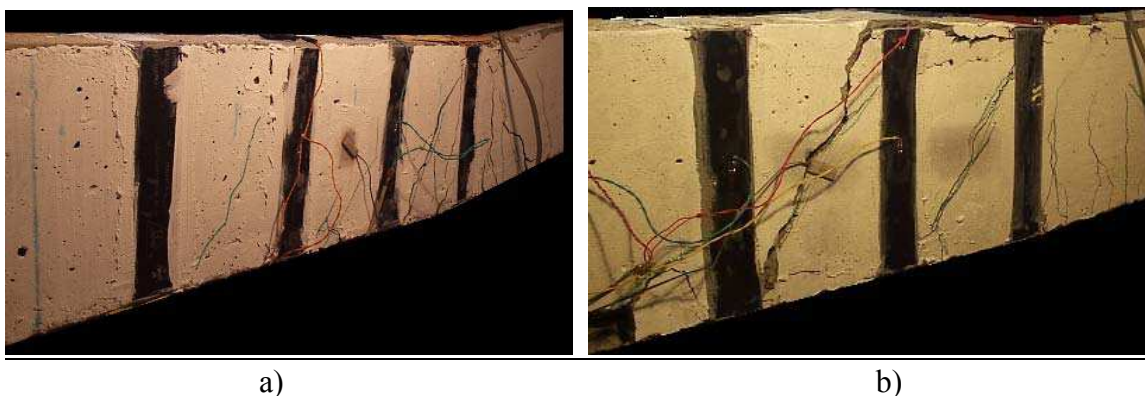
Vigas após ensaio do Sistema Sika® CarboDur: a) entre estribos e b) sobre estribos.
